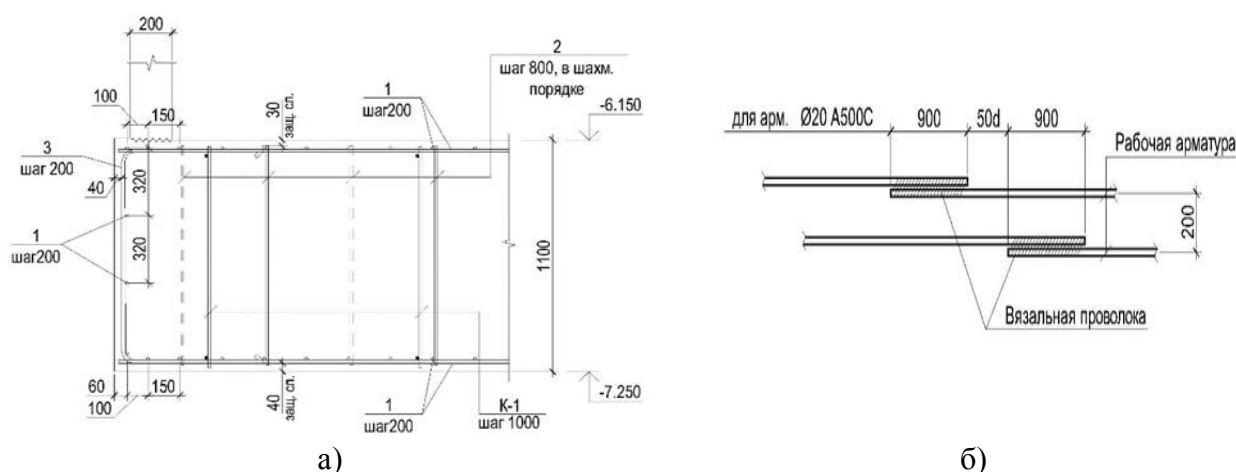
Армирование фундаментной плиты: а) деталь основного армирования фундаментной плиты; б) соединения стержней рабочей арматуры внахлест (взято из проекта № 2287-01/00,01,02, МГП АПМ Веснина)
